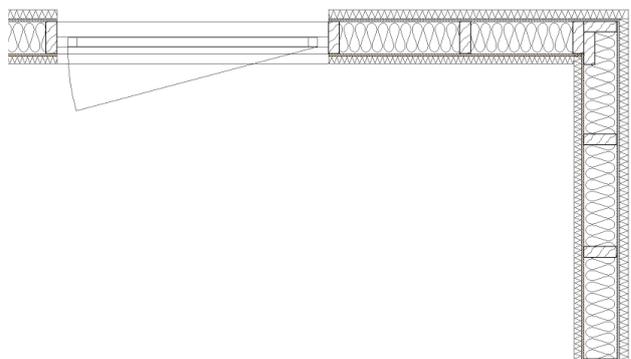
Ausbildung der Rahmenkonstruktion in einer Wandecke
